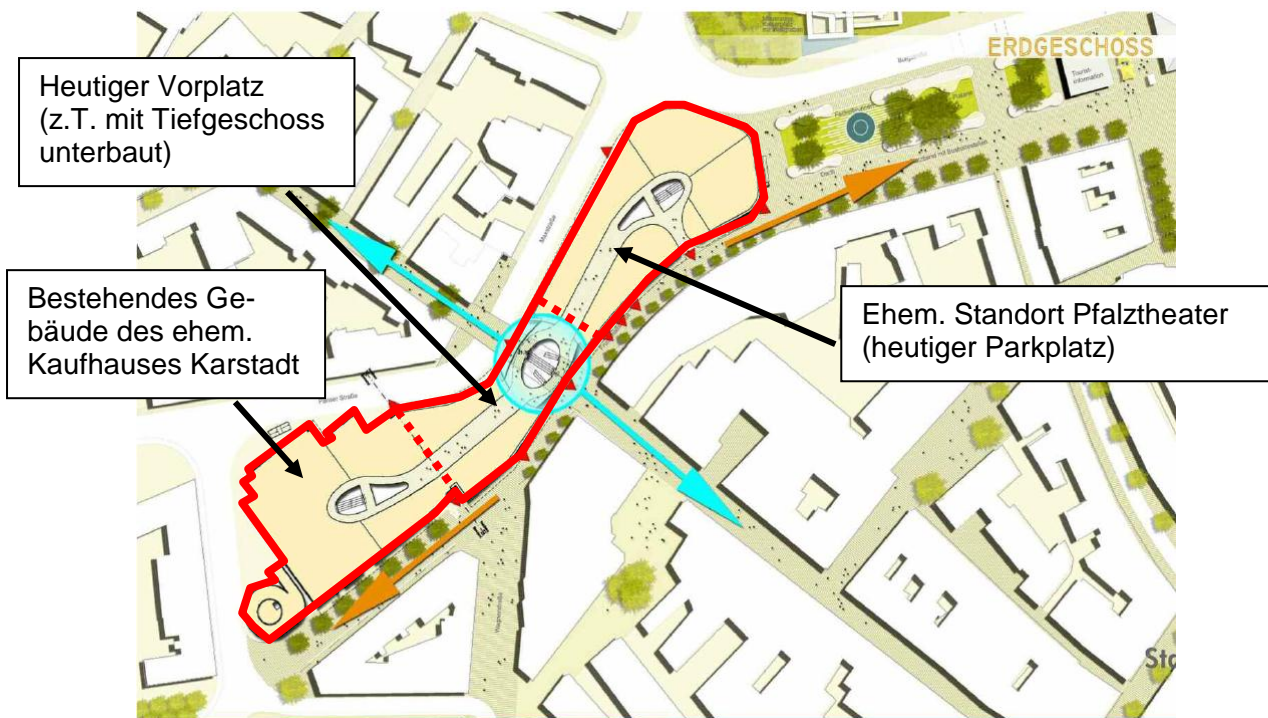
Lage der geplanten Stadtgalerie (rote Linie) und heutige Bebauung/ Nutzung
